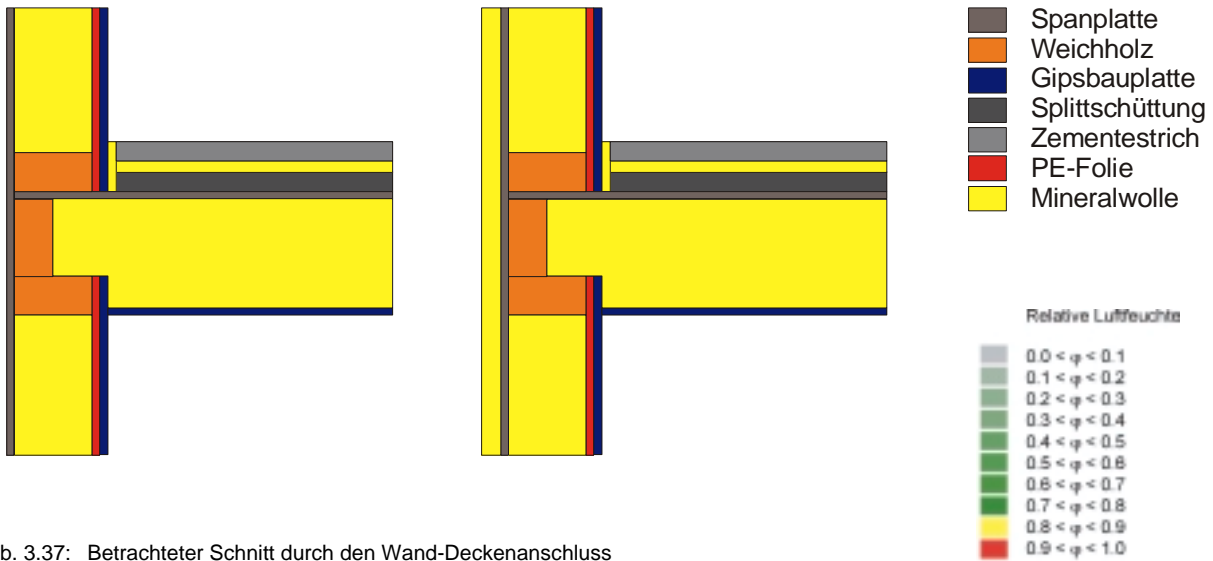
Betrachteter Schnitt durch den Wand-Deckenanschluss ohne (links) und mit (rechts) zusätzlicher außen liegender Wärmedämmung
